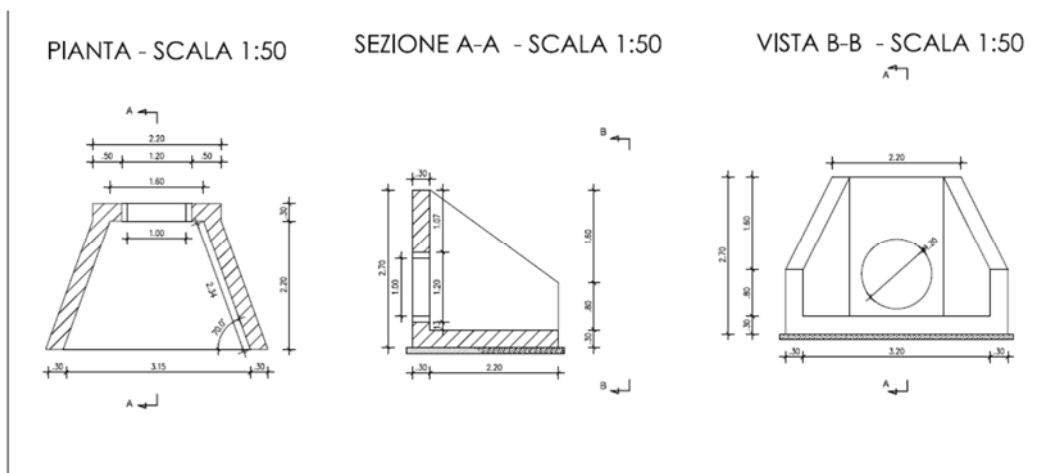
manufatto di dimensioni 2.5x2.4x0.8mt
